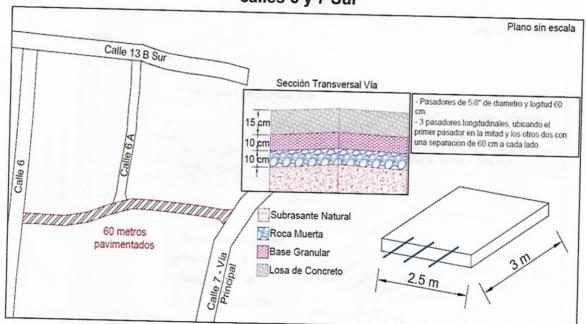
Plano y sección transversal carrera 13C sur entre calles 6 y 7 Sur
